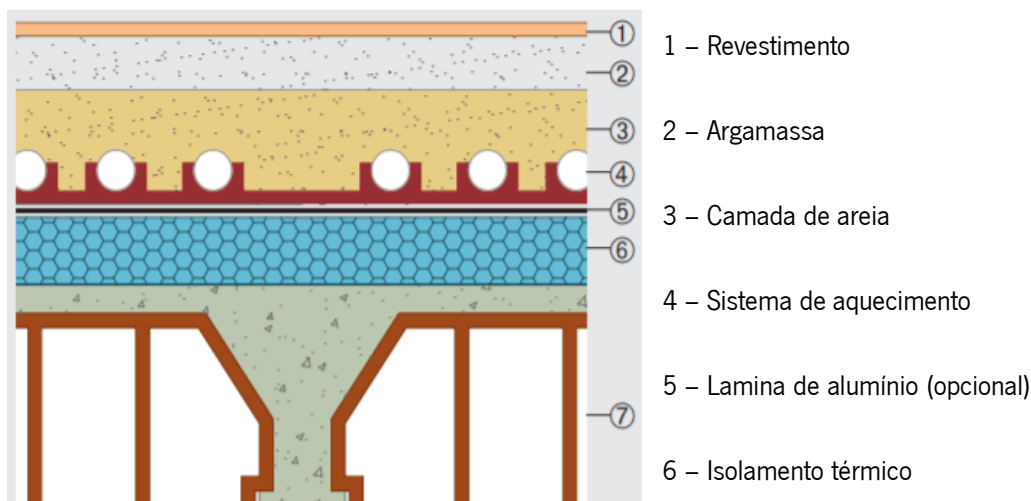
Pormenor construtivo tipo de um pavimento com isolamento térmico na face superior de laje (DOW , n.d.)
